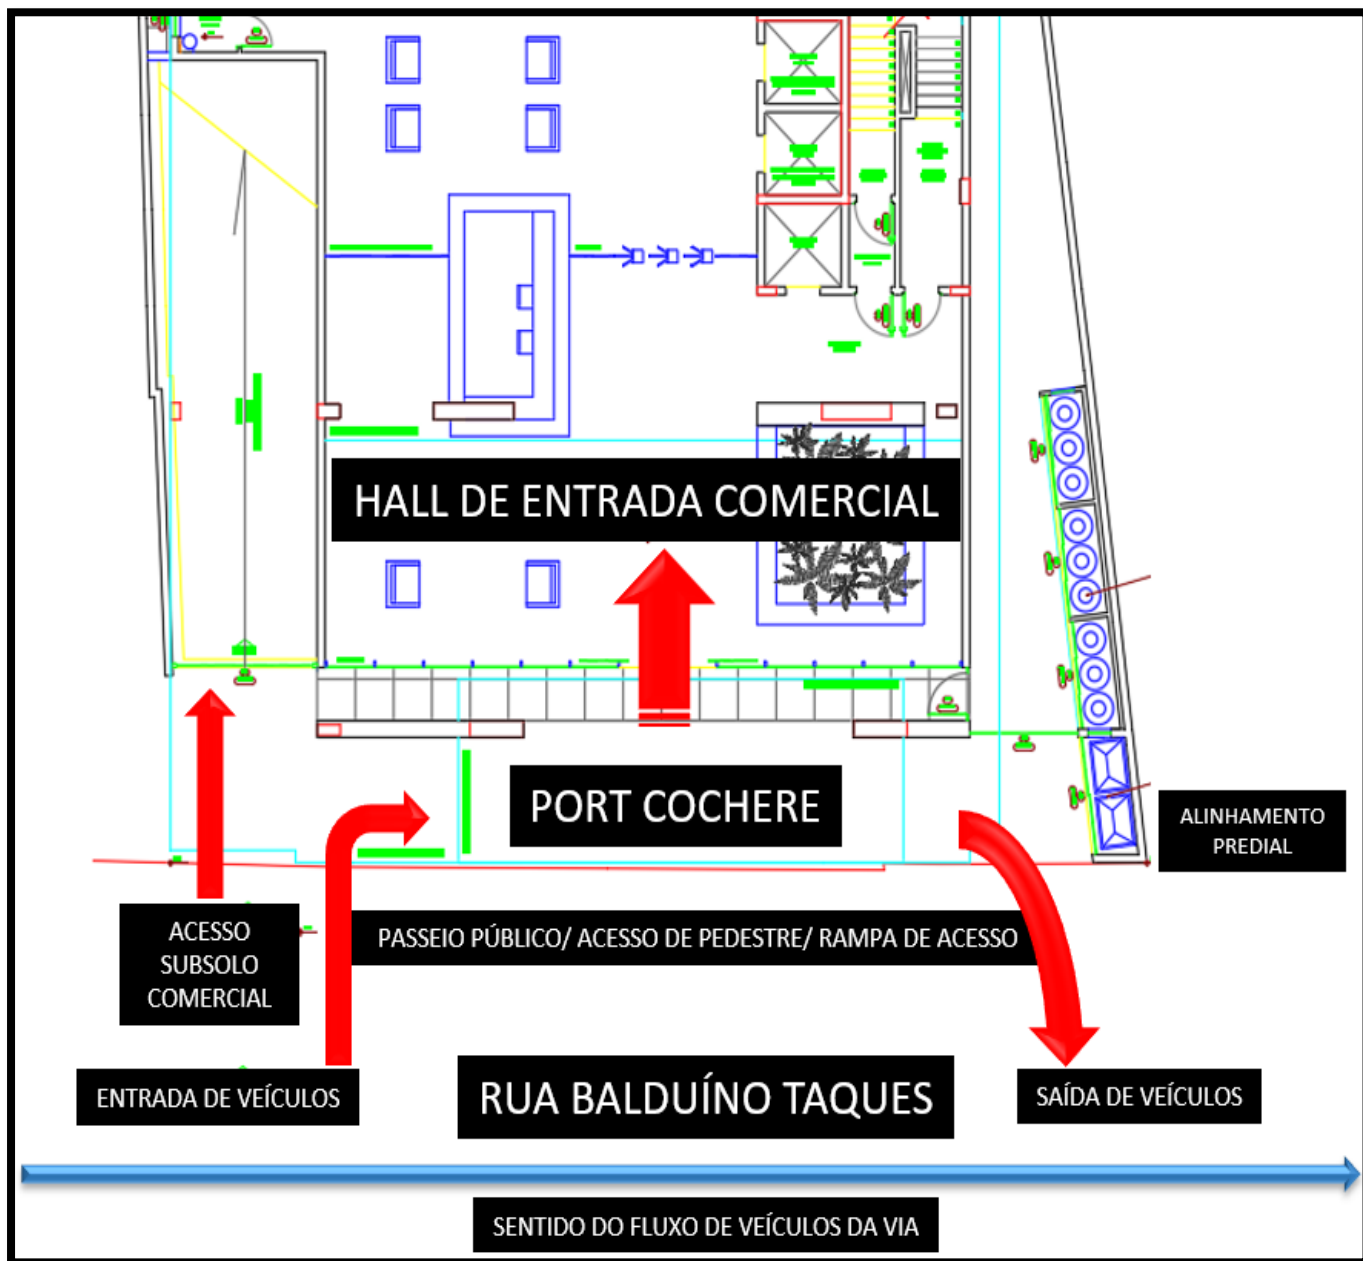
Acesso de pedestres Hall de entrada Comercial – Planta Baixa
